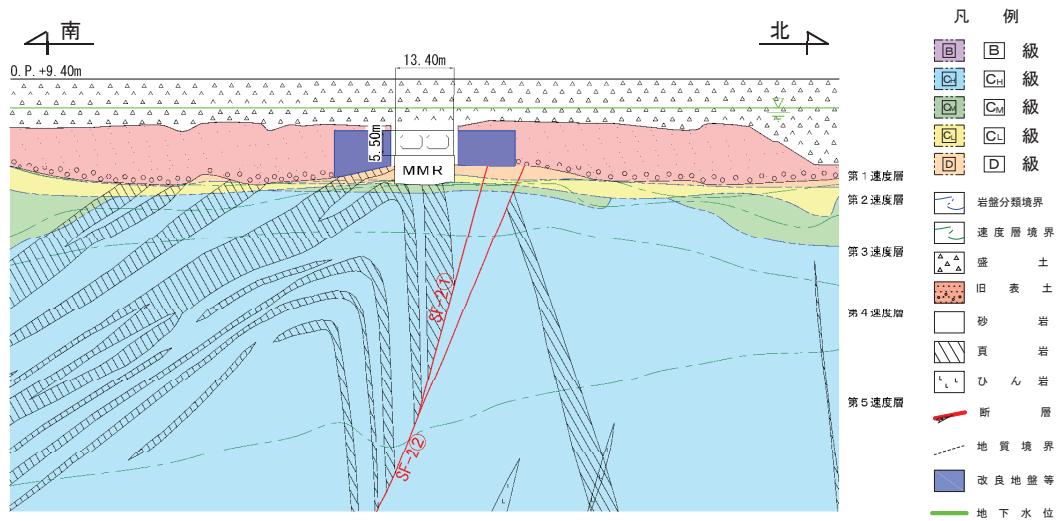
取水路（標準部）地質断面図（断面③：直線部）
